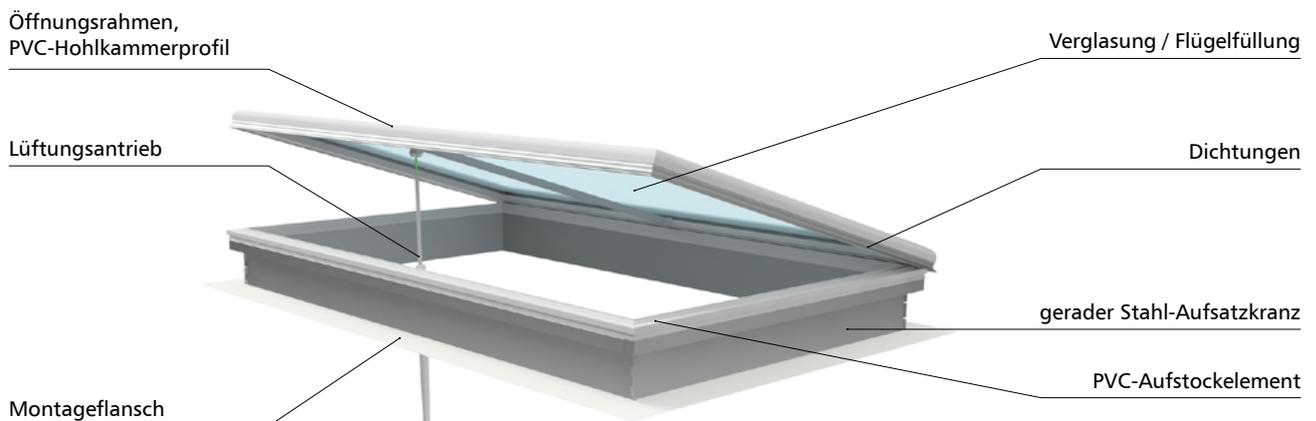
Aufbau einer Lüftungsklappe mcr ULTRA THERM Typ E mit elektrischem Lüftungsantrieb
